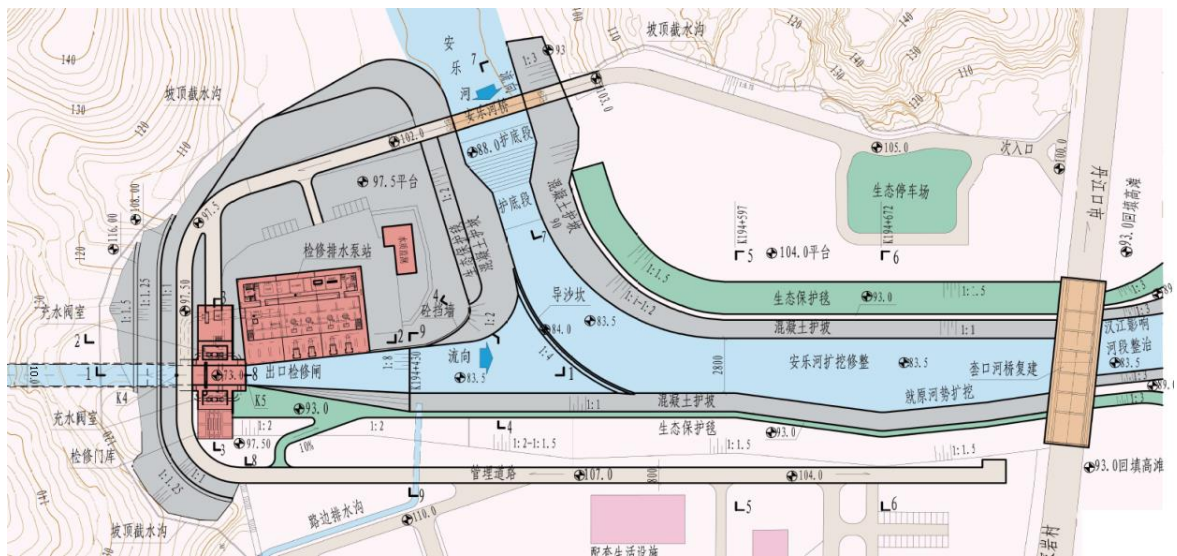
出口检修闸及排水泵站平面布置图
